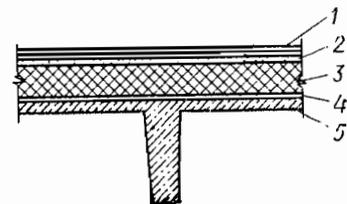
Схема железобетонного покрытия с пенобетонным утеплителем:
